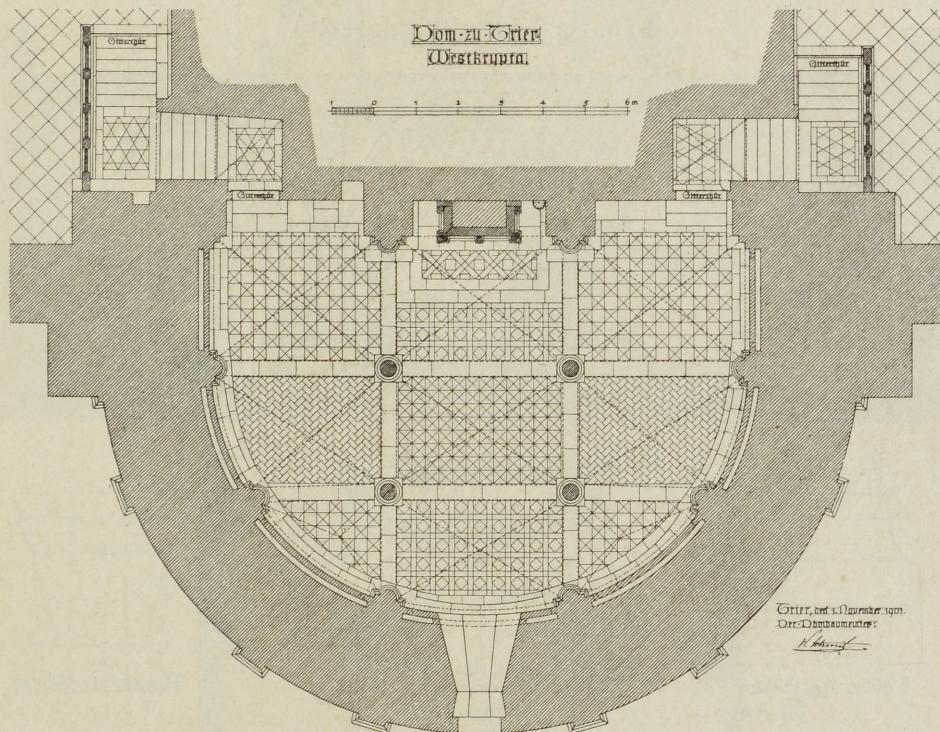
Trier, Dom. Grundriss der Westkrypta.
